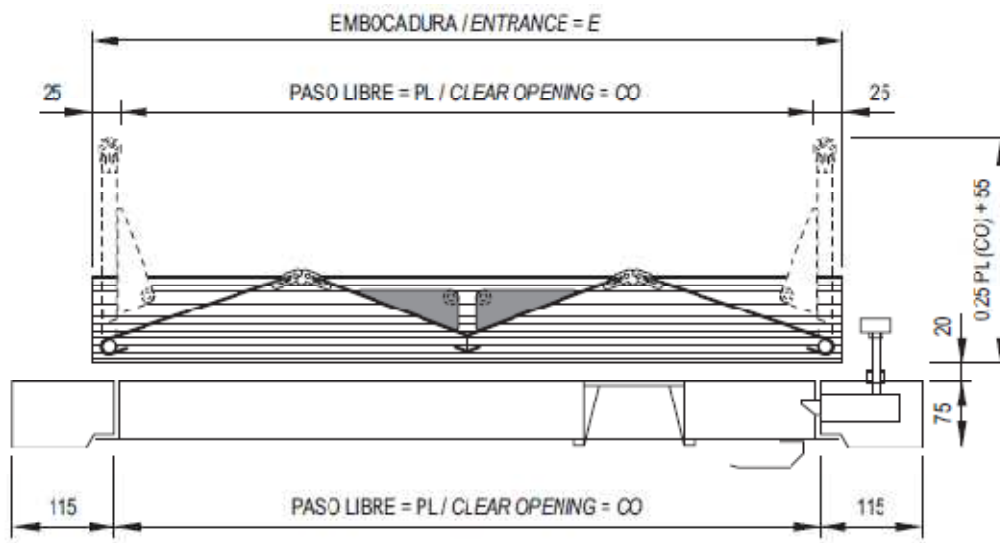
Plano Descriptivo de puertas plegables (Fuente: Fermator)
